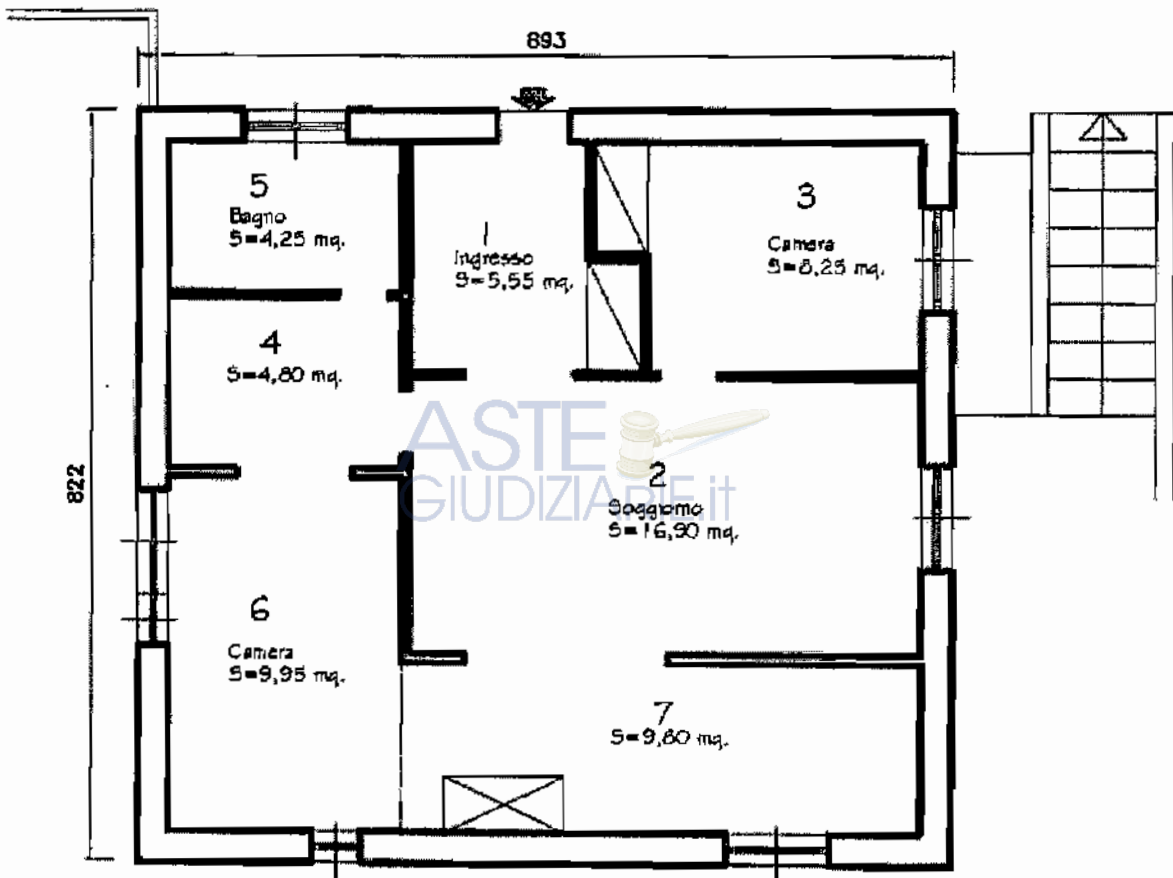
planimetria appartamento civ. 13 Piano terra.
